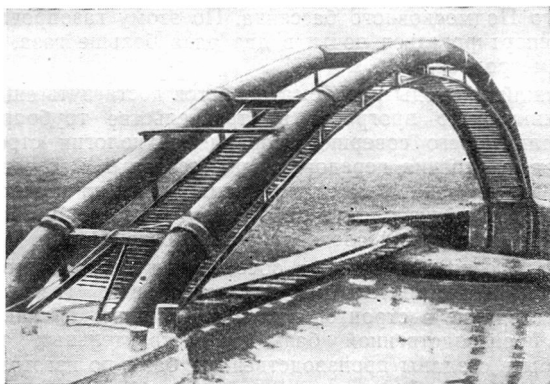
Общий вид двухниточного арочного перехода через Язузу.
